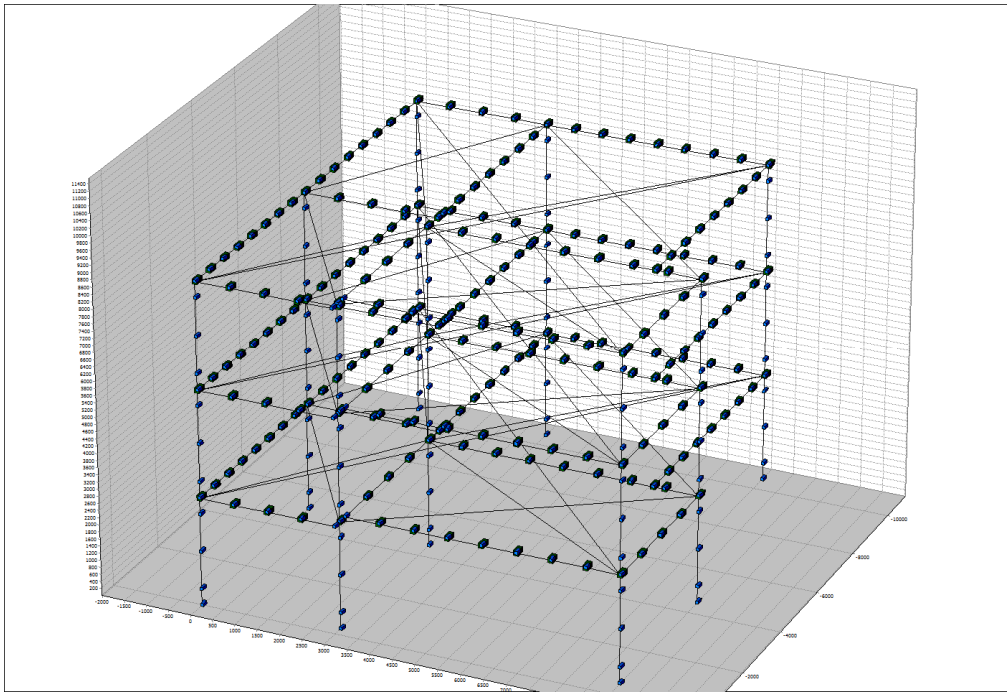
SPEAR yapısı plan görünümü [53].
